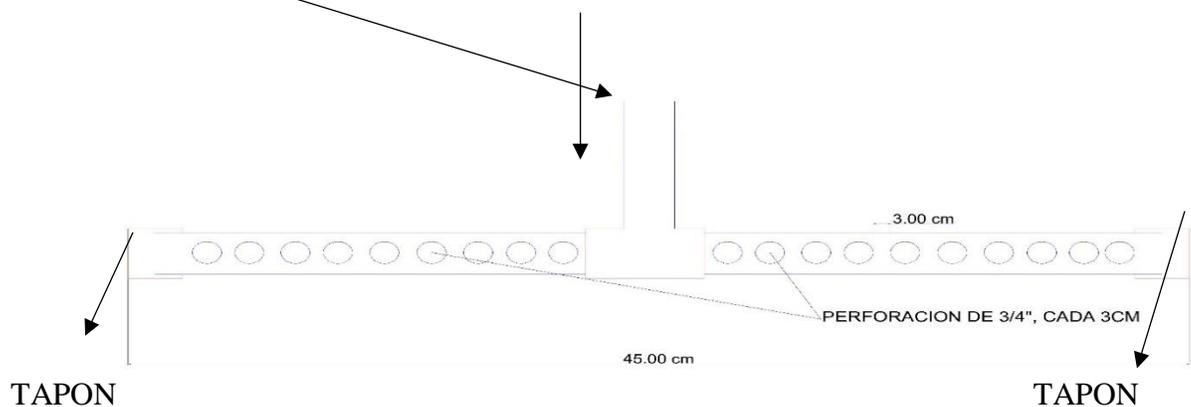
Tubería de distribución la Planta Piloto con perforación de  $\frac{3}{4}$ "
